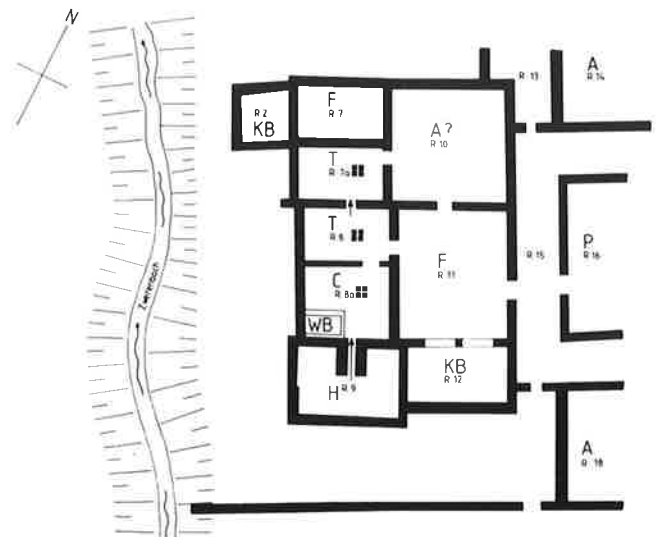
Bauphase 5; schematischer Grundriss
